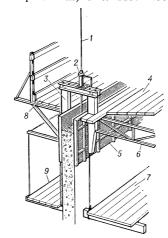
Скользящая опалубка (фрагмент): 1— домкратный стержень; 2— гидравлический домкрат; 3— домкратная рама; 4— рабочий настил; 5— шит опалубки; 6— каркас рабочего настила; 7— внутренние подвесные подмости; 8— козырёк ио наружному периметру опалубки; 9— наружные подвесные подмости.
